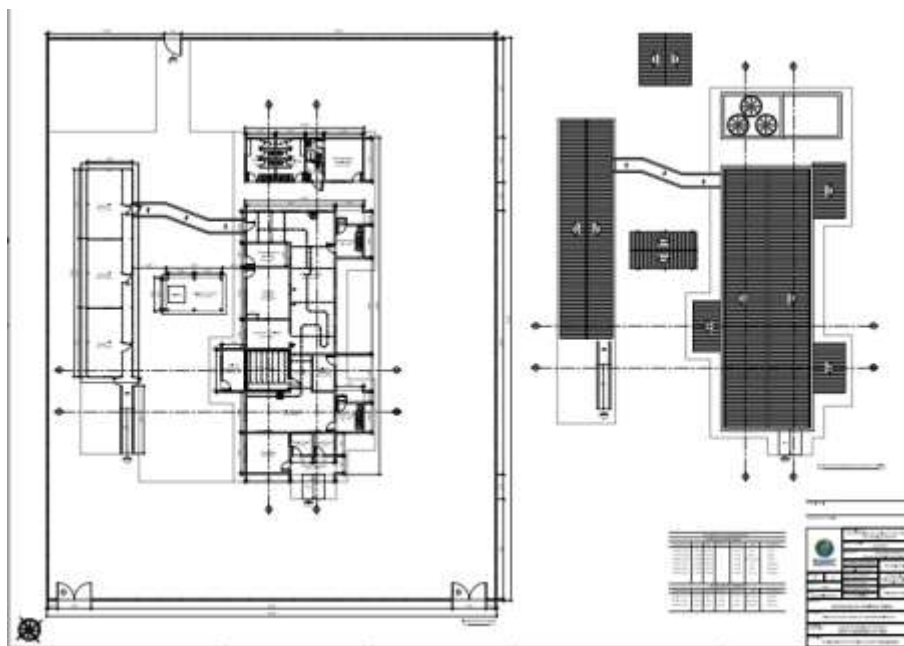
Planta baixa e de cobertura da agroindústria da COOAFAP. Masset Ambiental, 2017.
